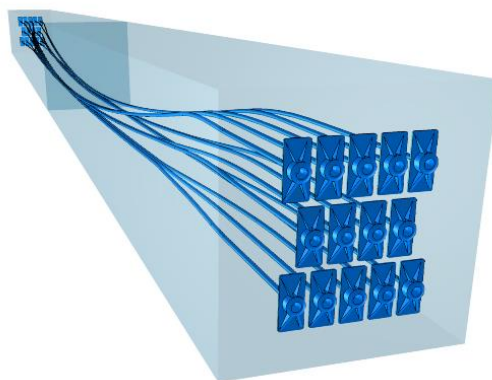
Disposição das ancoragens da viga V5 protendida (14 cabos).
